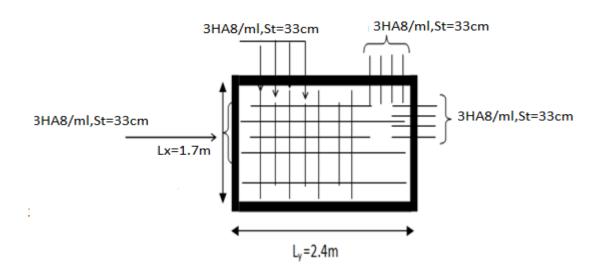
Schéma de ferraillage de la dalle sur quatre appuis
